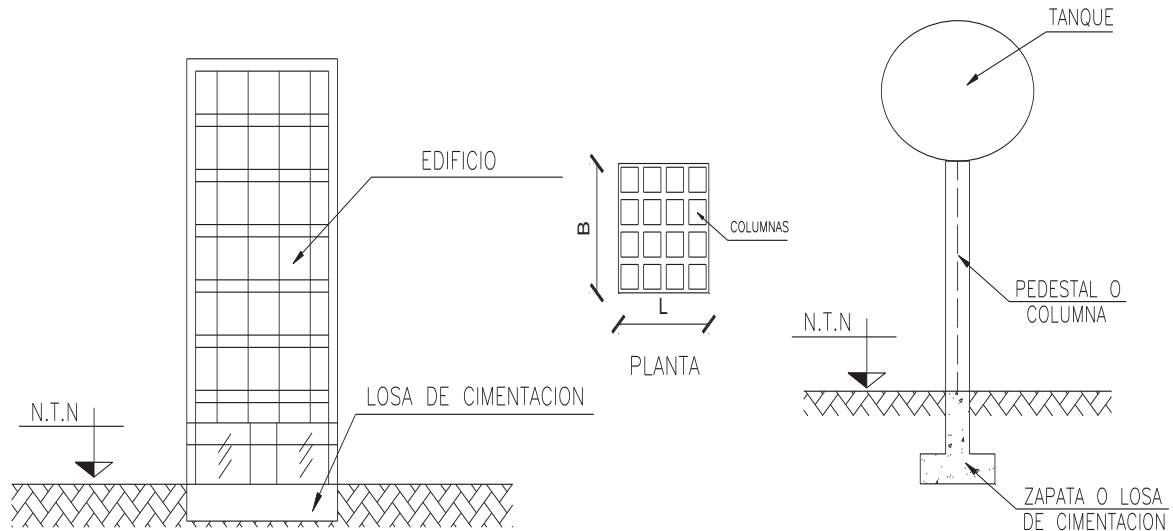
Losas de Cimentación en Diferentes Estructuras
